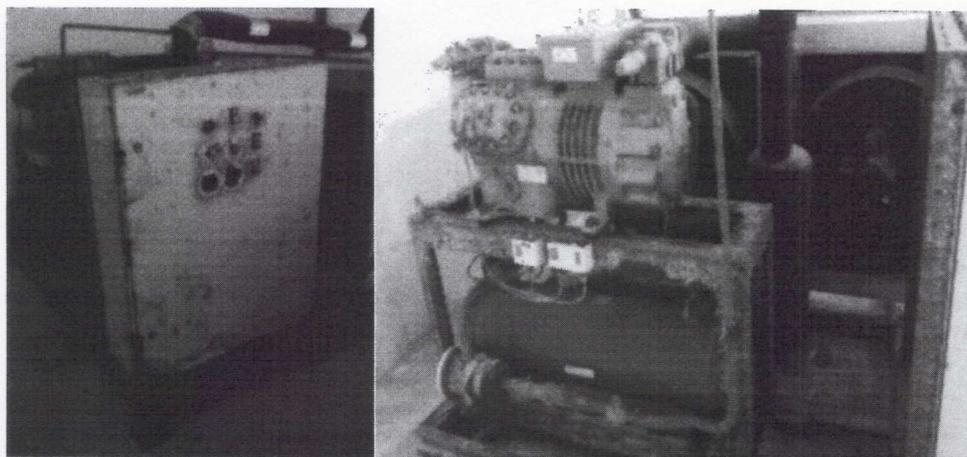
2º Pavimento, telhado acima das câmaras de estocagem.
